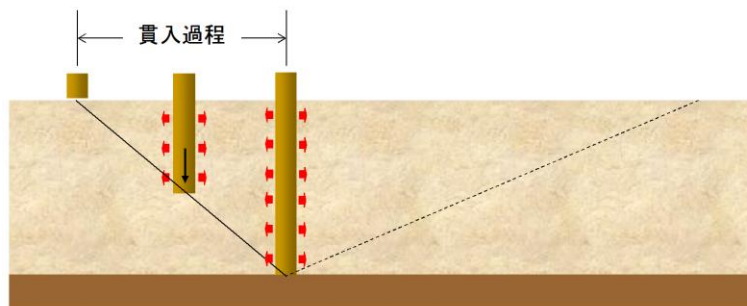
SCP 工法と締固め杭工法の施工方法の相違¹⁴⁾に加筆・修正
